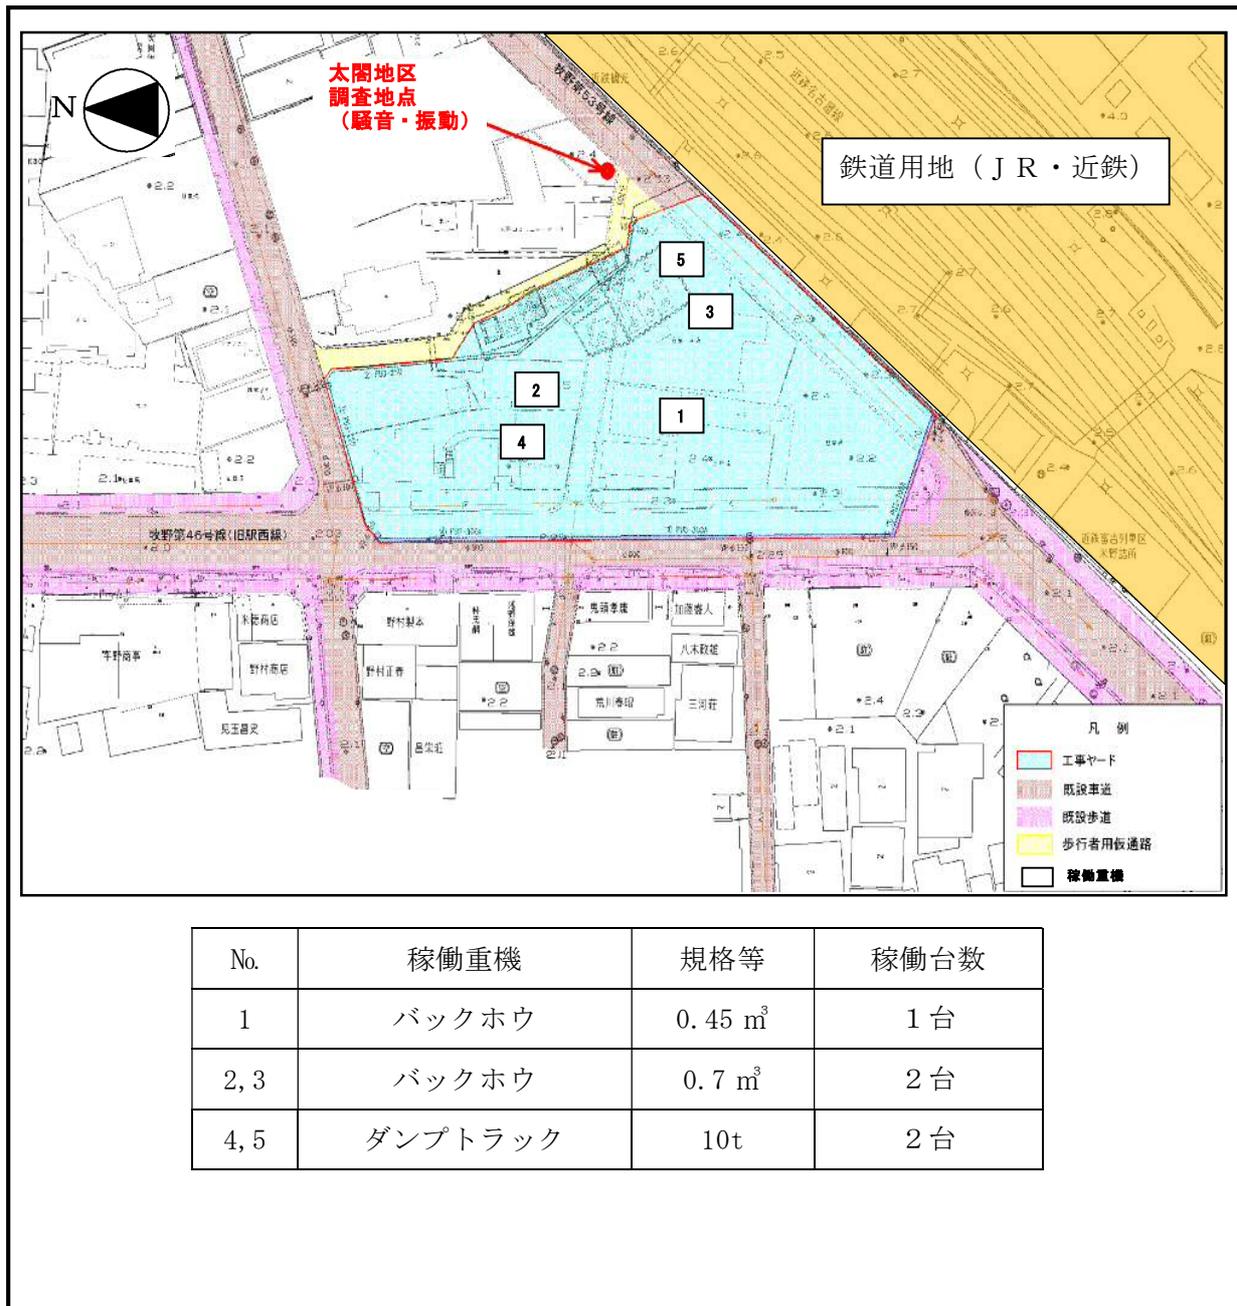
(1) 建設機械配置図 (函体工事 (土工) : 太閤地区)
